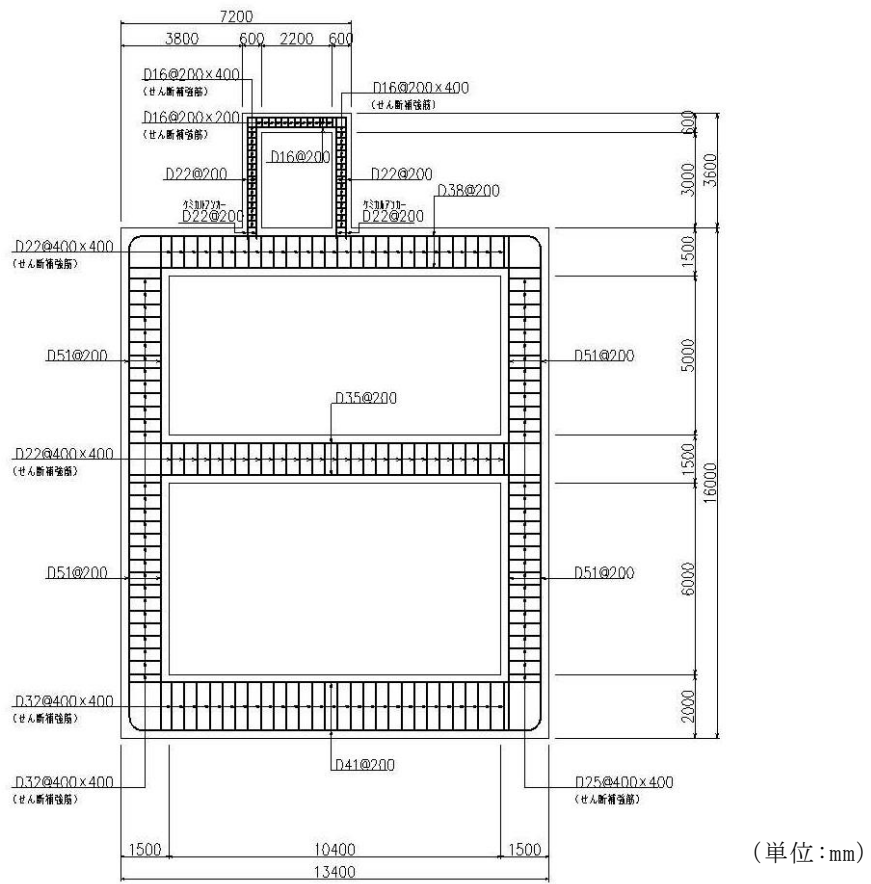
低圧原子炉代替注水ポンプ格納槽 概略配筋図 (A-A 断面)
